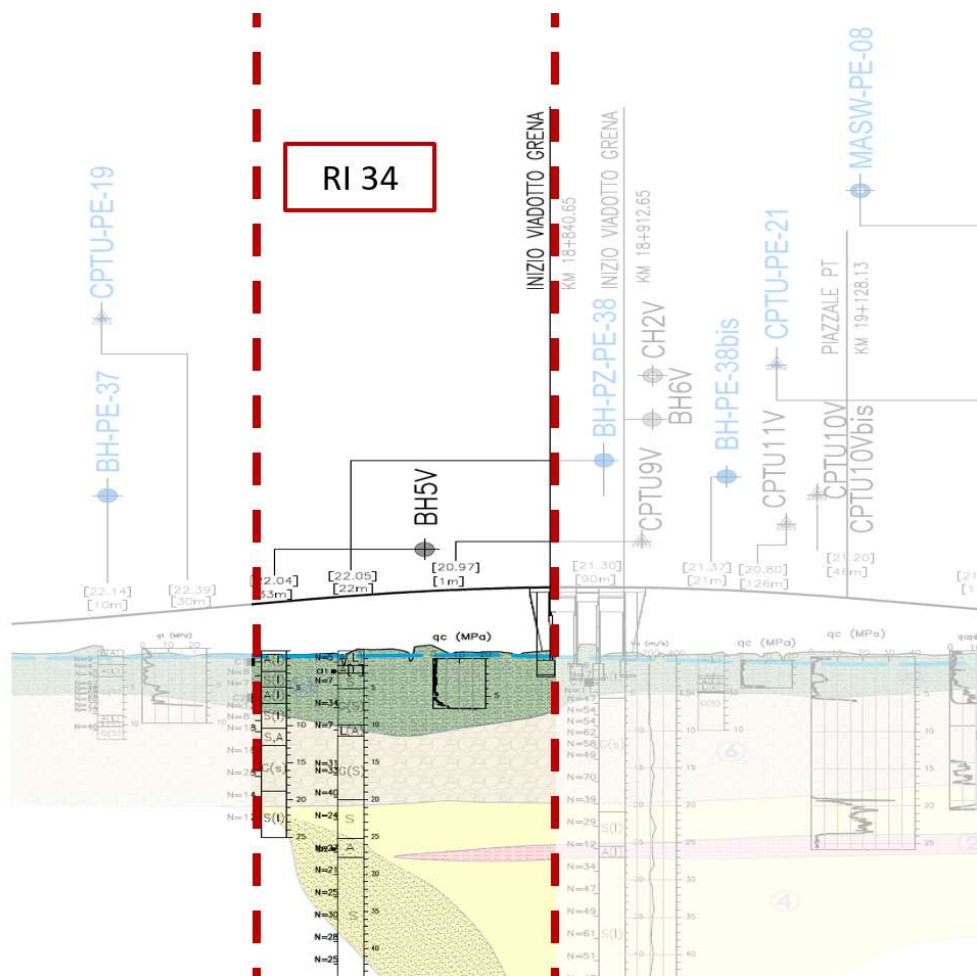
Profilo Geotecnico Rilevato RI34, estratto dal Profilo Geotecnico Generale (Doc. Rif. [3])
